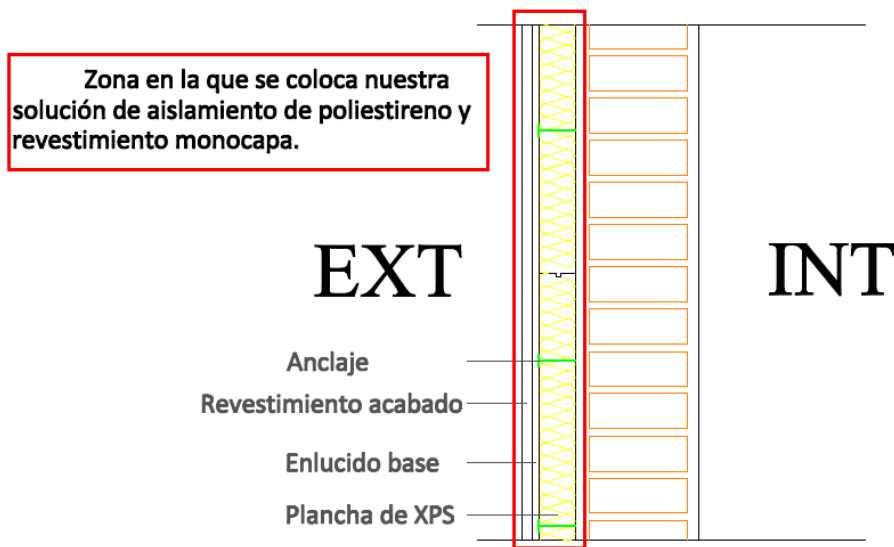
Detalle reforma exterior de XPS para revestir.
